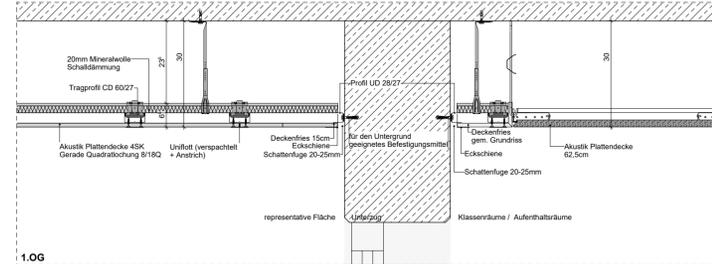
Decke 1 - gleitender Anschluss Unterzug
